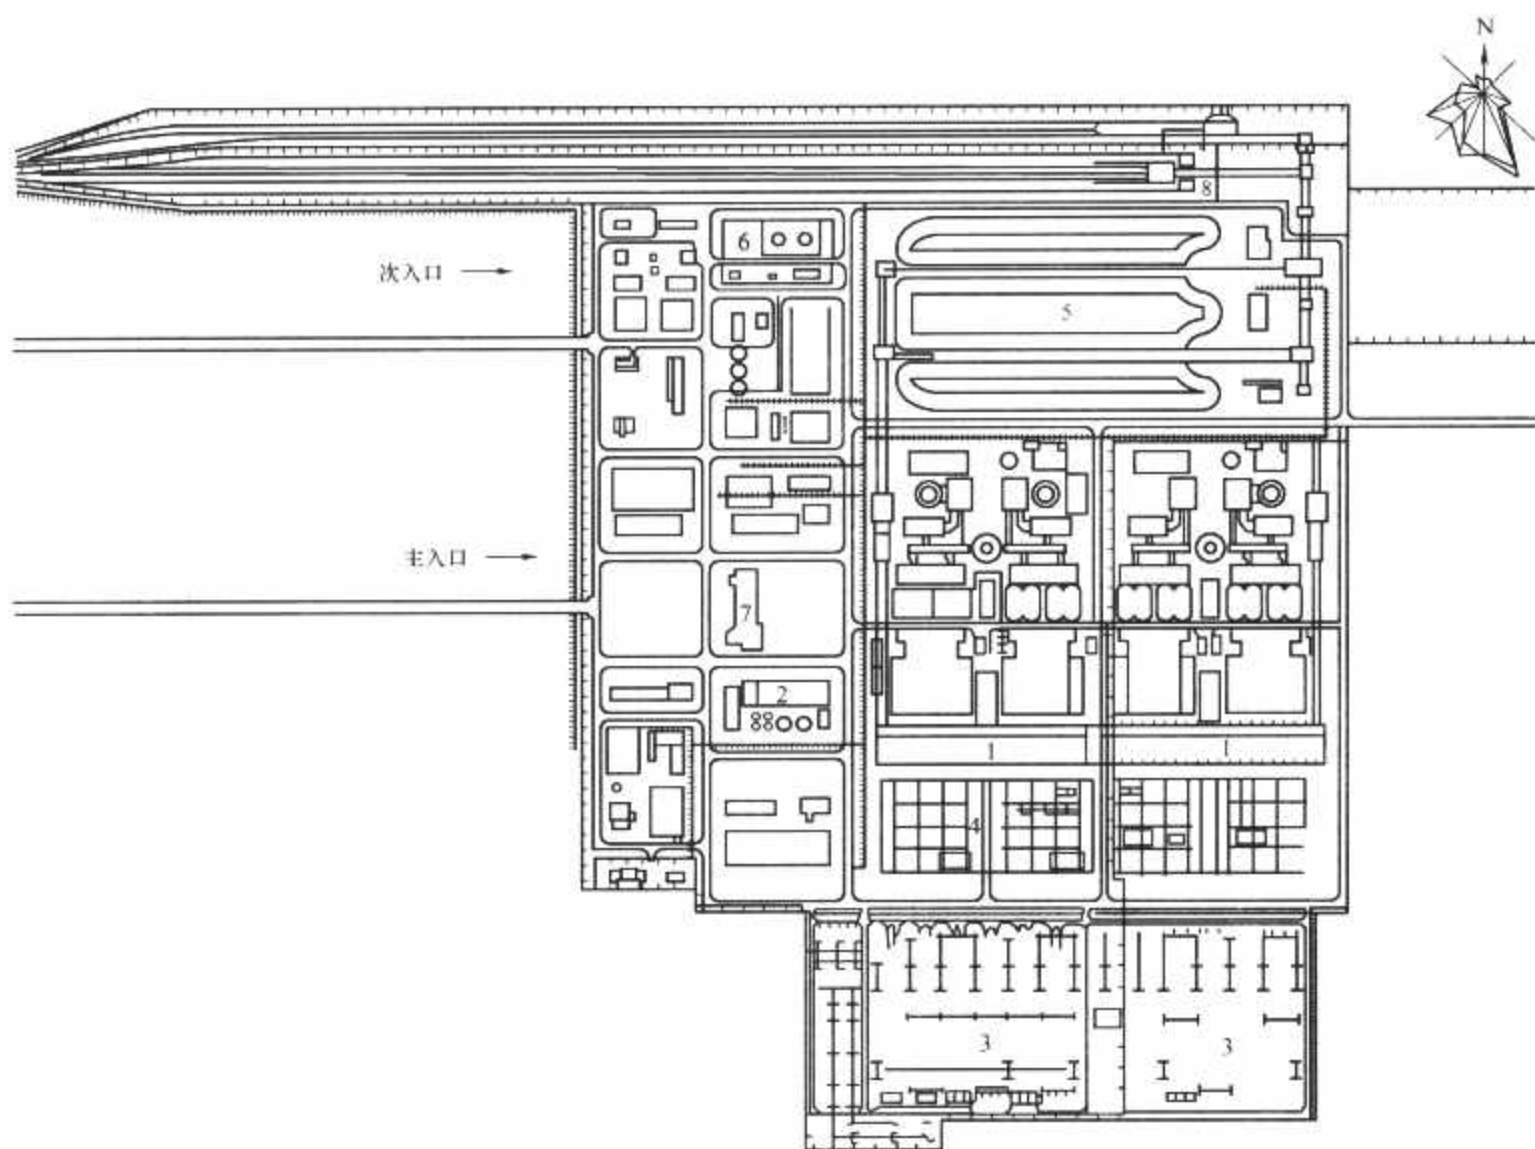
直接空冷机组三列式电厂总平面布置图
